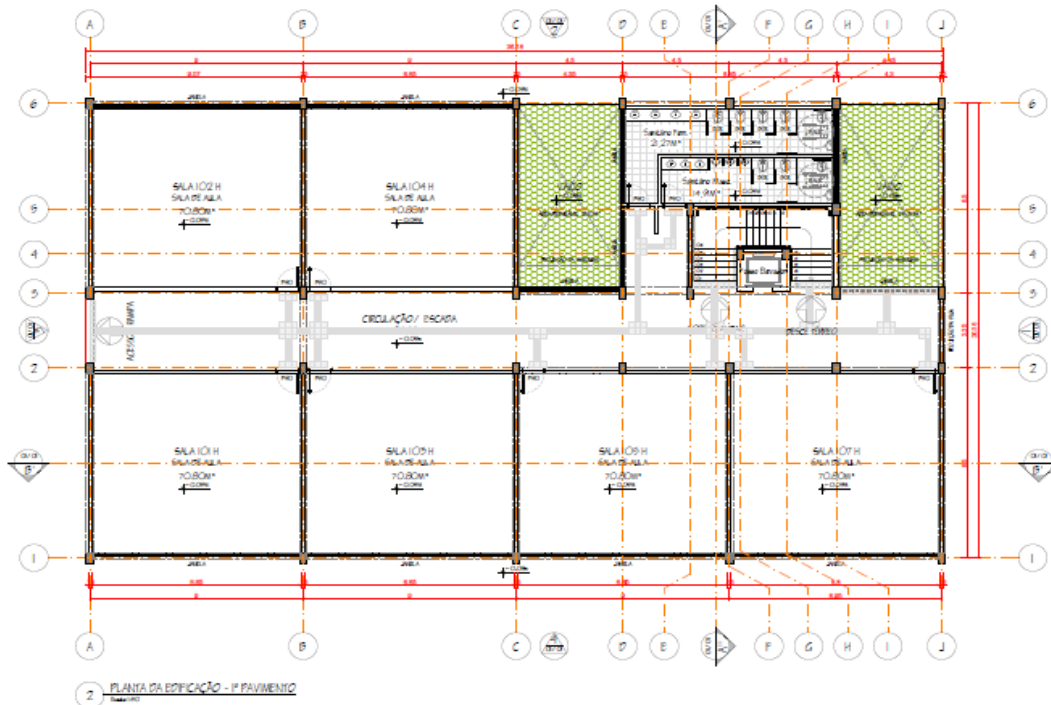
Edificação selecionada para estudo “Bloco H” (Imagem retirada da planta baixa da edificação).
